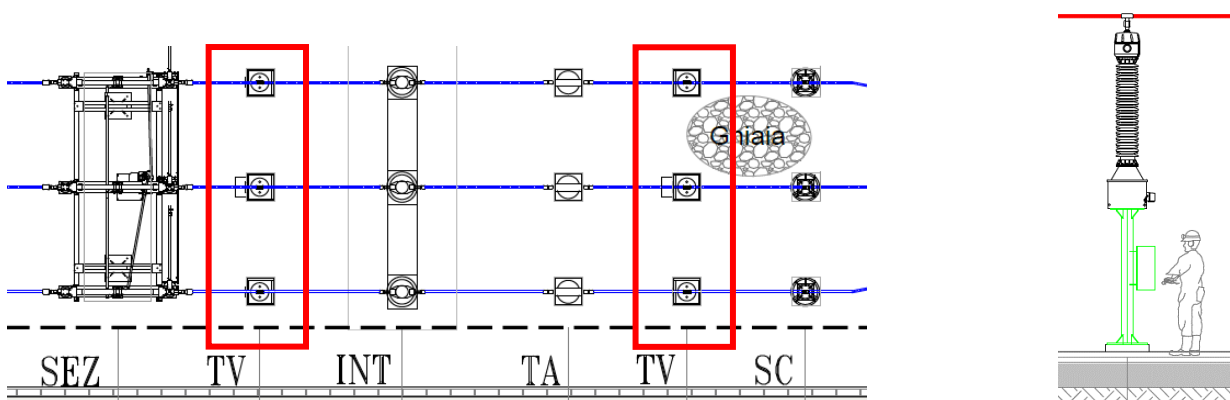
Tipico Trasformatore di tensione – vista prospettica e planimetrica
